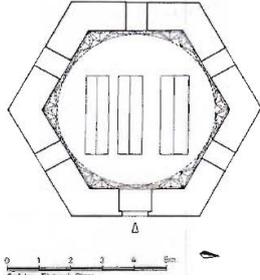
مسقط أفقي لتربة عيني علي في ماغنيسا
